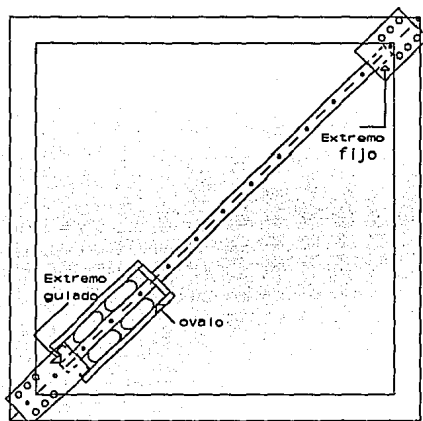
Dispositivo modular de disipadores tipo óvalo montado en un marco estructural
